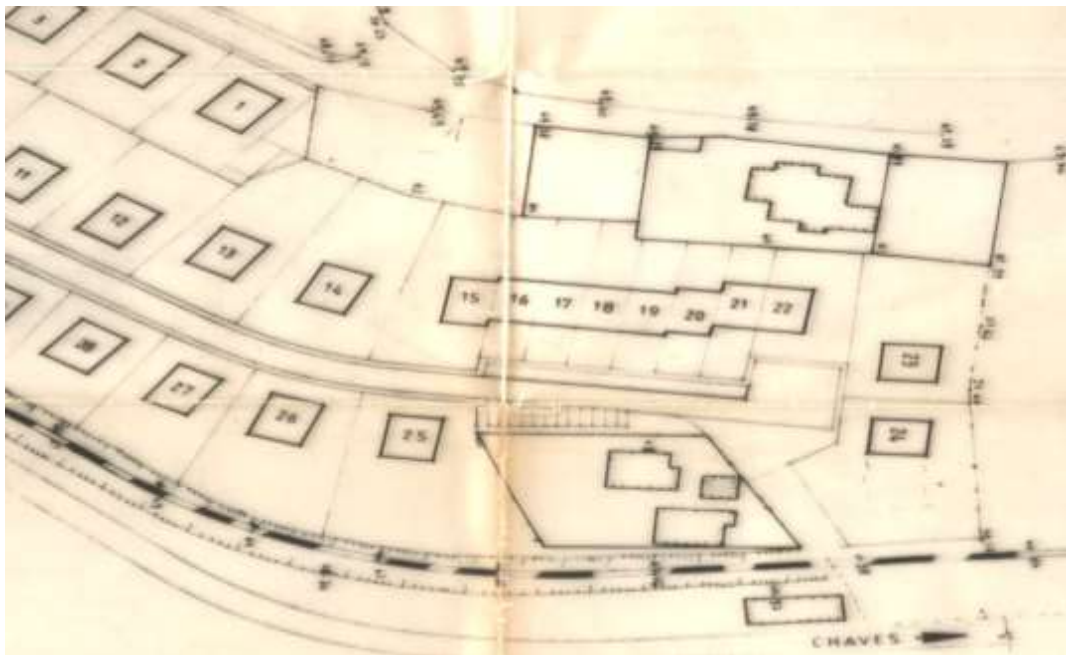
extrato da planta de síntese do loteamento com alvará n° 10/92. -----
